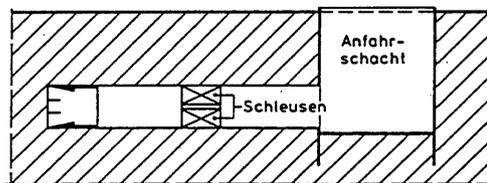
Schleuse stationär im Tunnel (umsetzbar)
